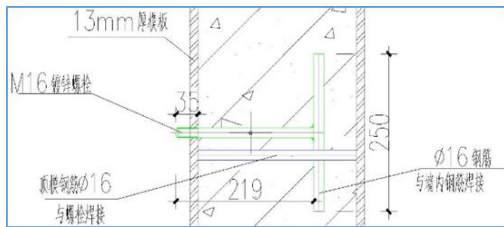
“螺栓上焊接顶模钢筋”实施示意图
